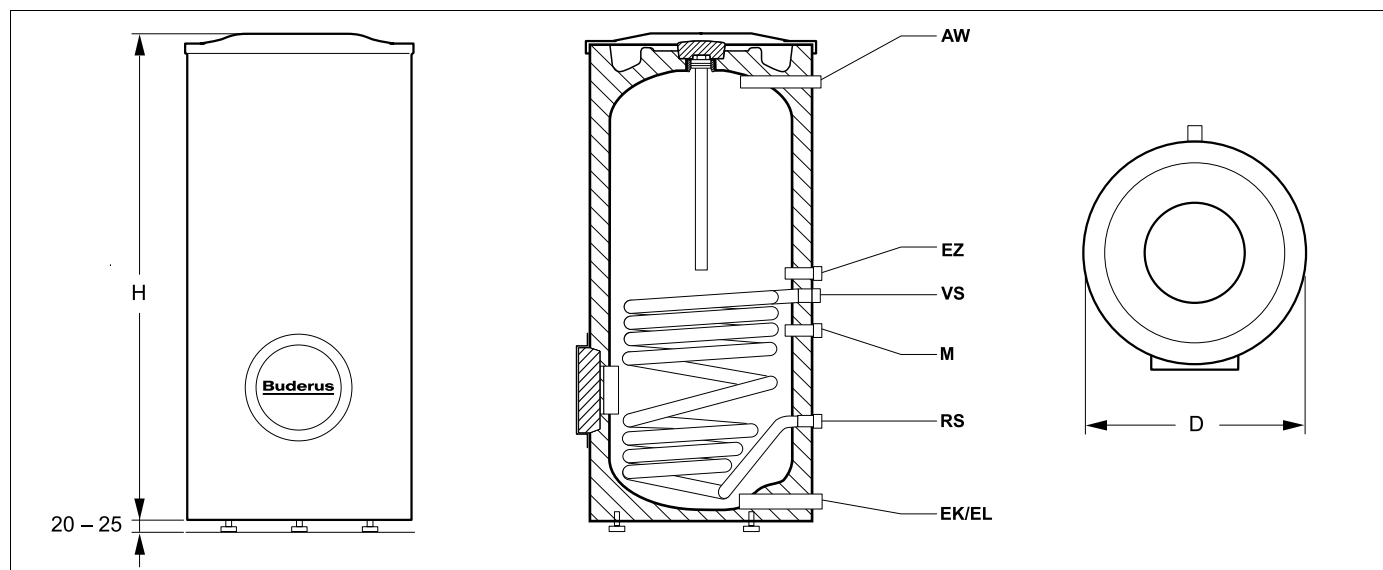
Dimensiuni și racorduri (cote în mm) – Schemă de principiu
